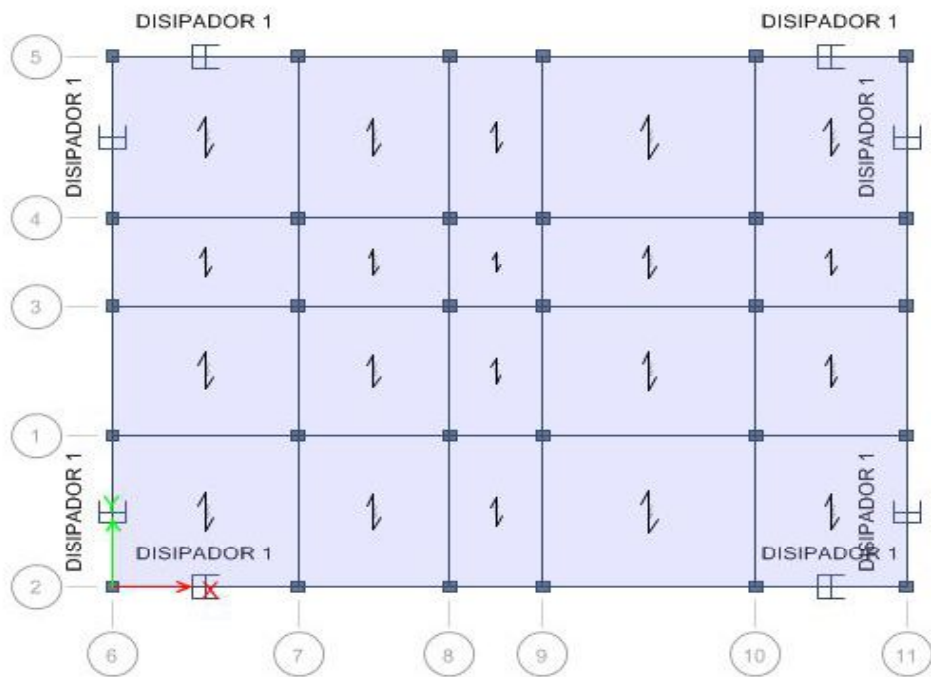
Vista en planta de los disipadores del 1er nivel en Etabs V13
